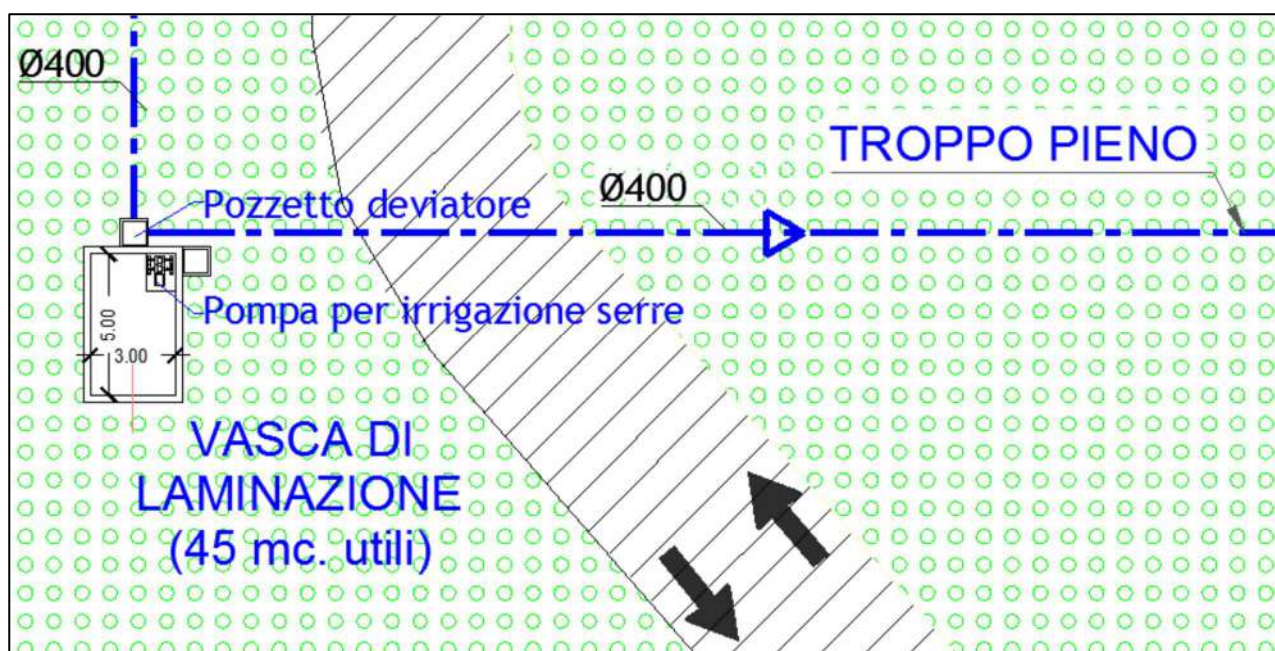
Dettaglio planimetrico vasca di laminazione esistente
